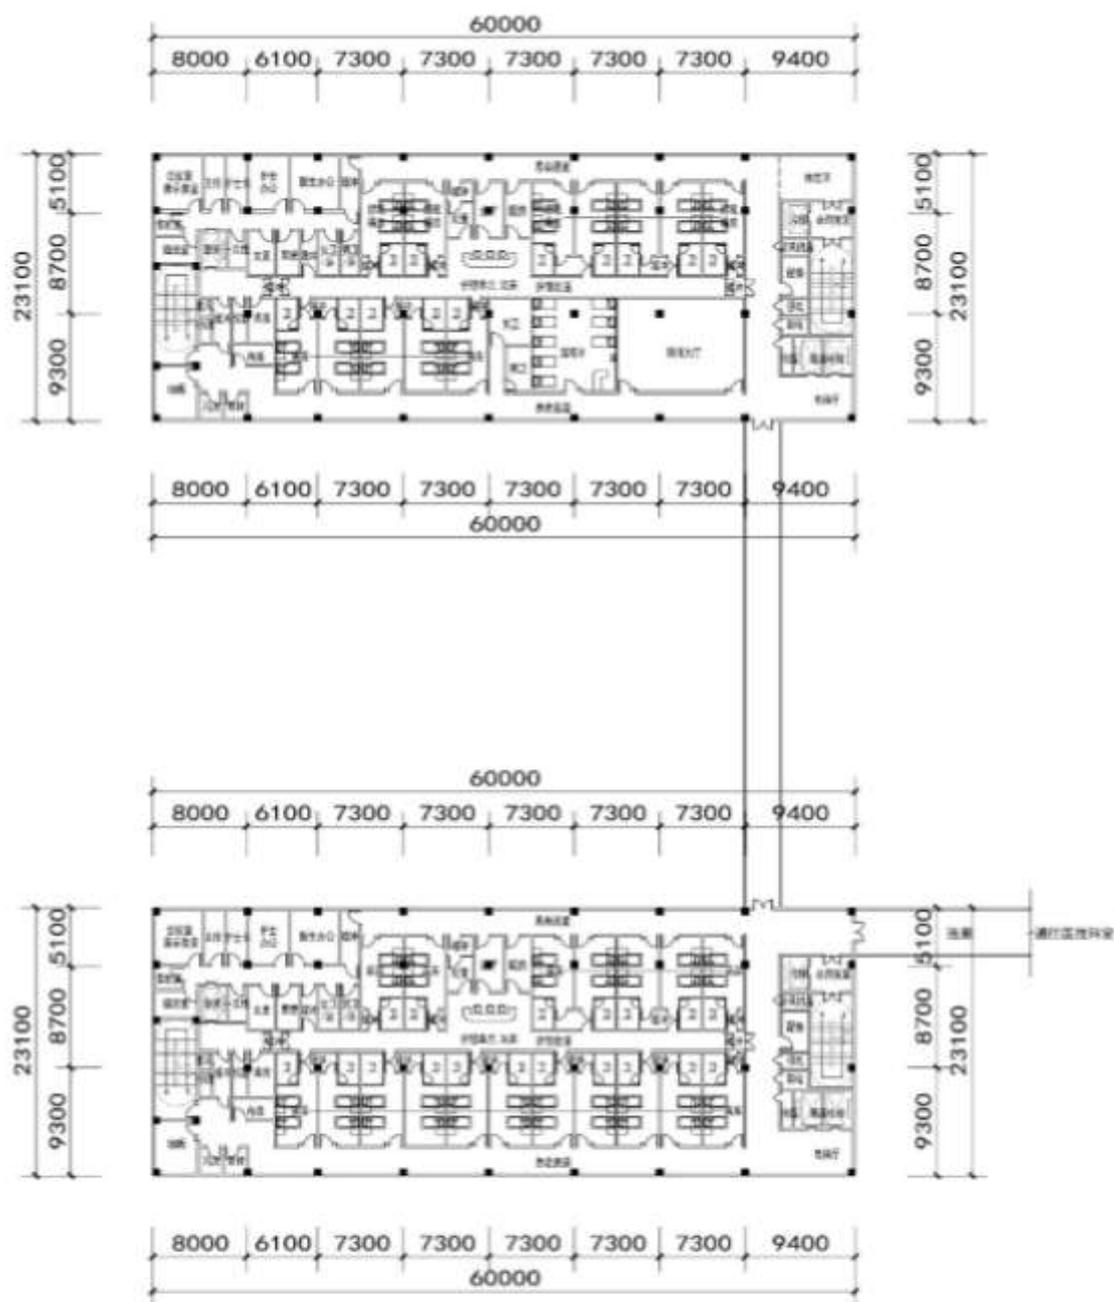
(2) 各层平面布置图 (北院区科技楼)
